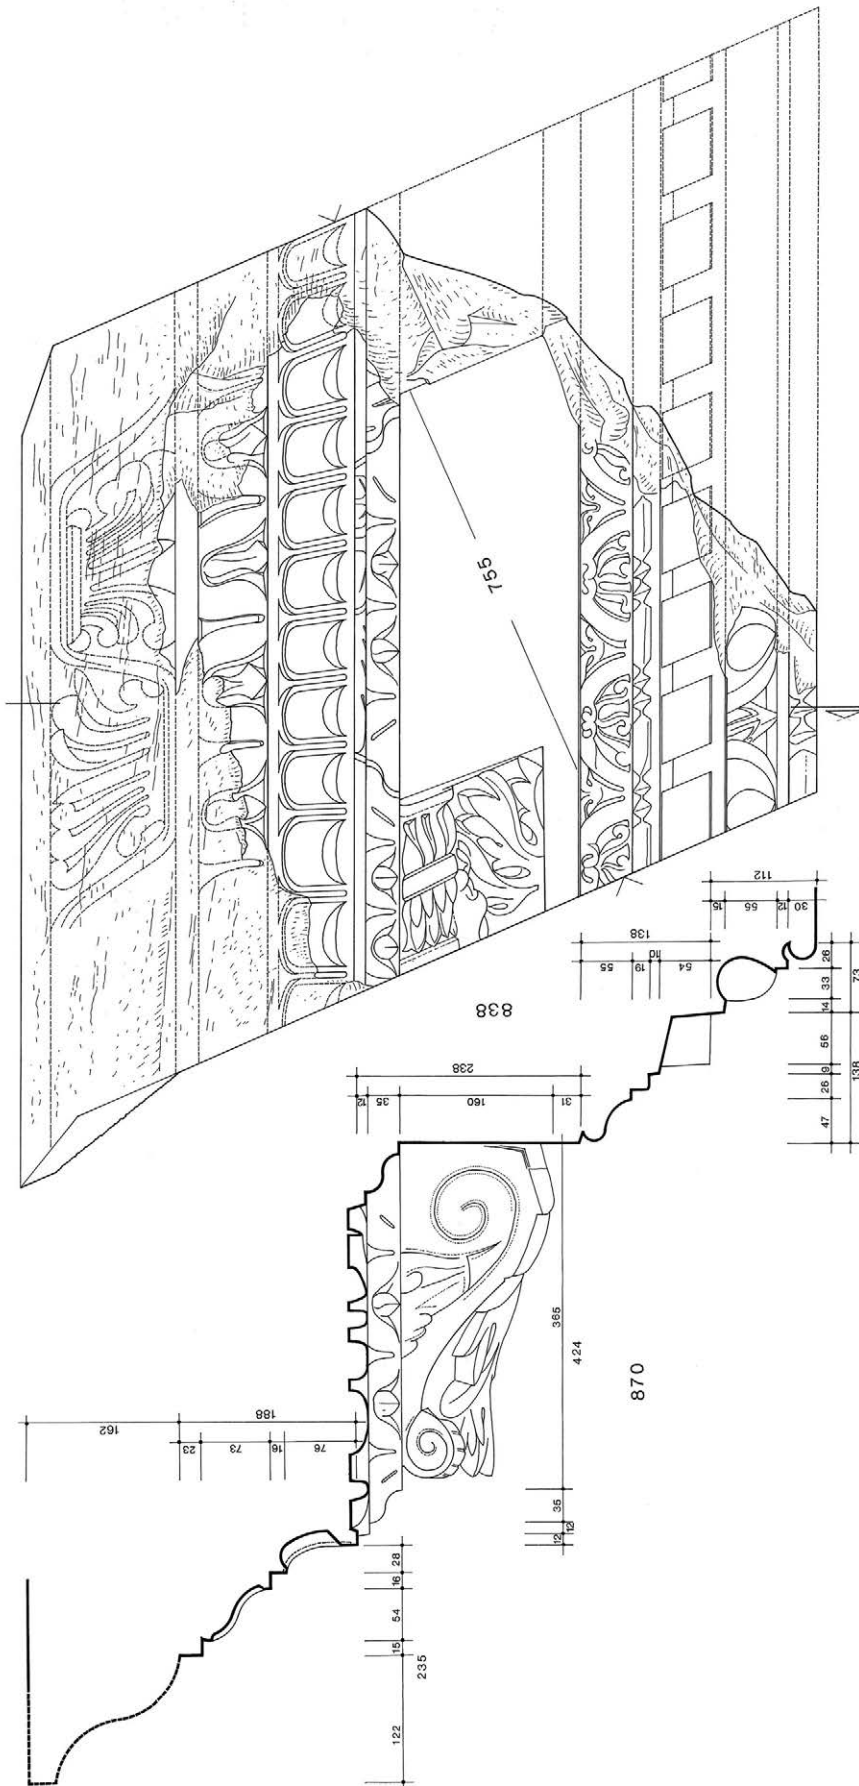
Temple A. Coupe et élévation du bloc faîtier du rampant de fronton de droite (G. Hallier).
